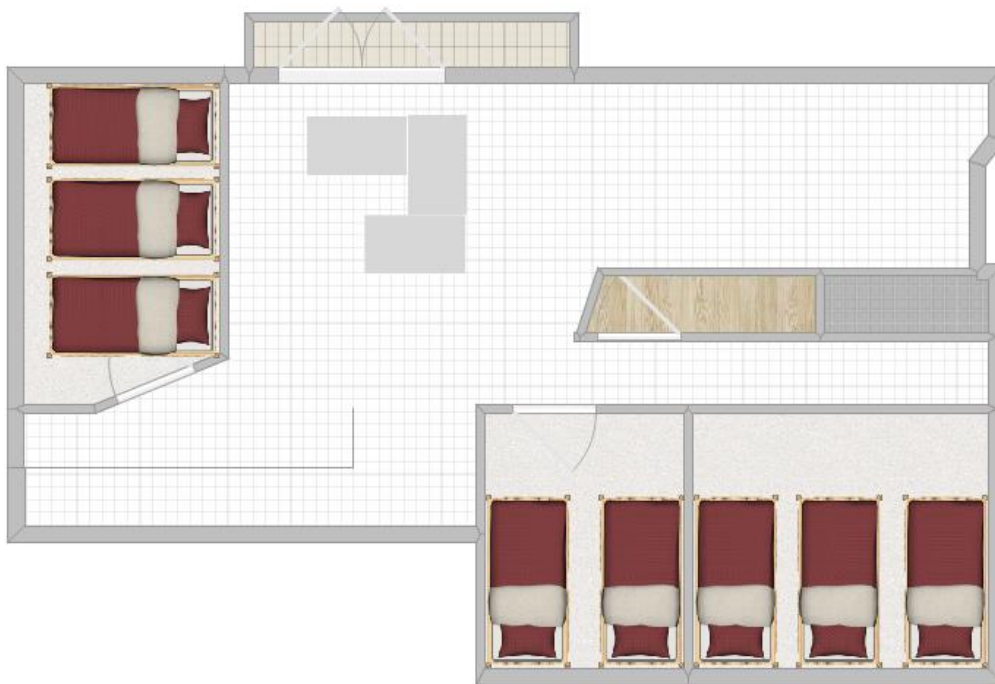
plano de la segunda planta de la Casa del Jardín.¹⁰¹
